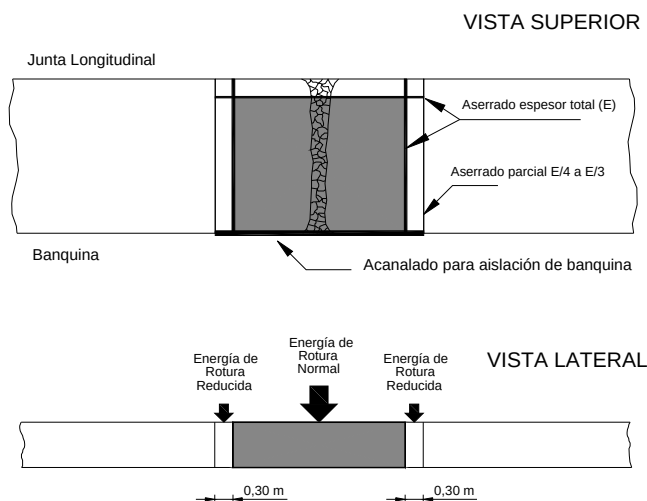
Cortes de protección para evitar roturas inferiores del hormigón sano en la zona perimetral.
